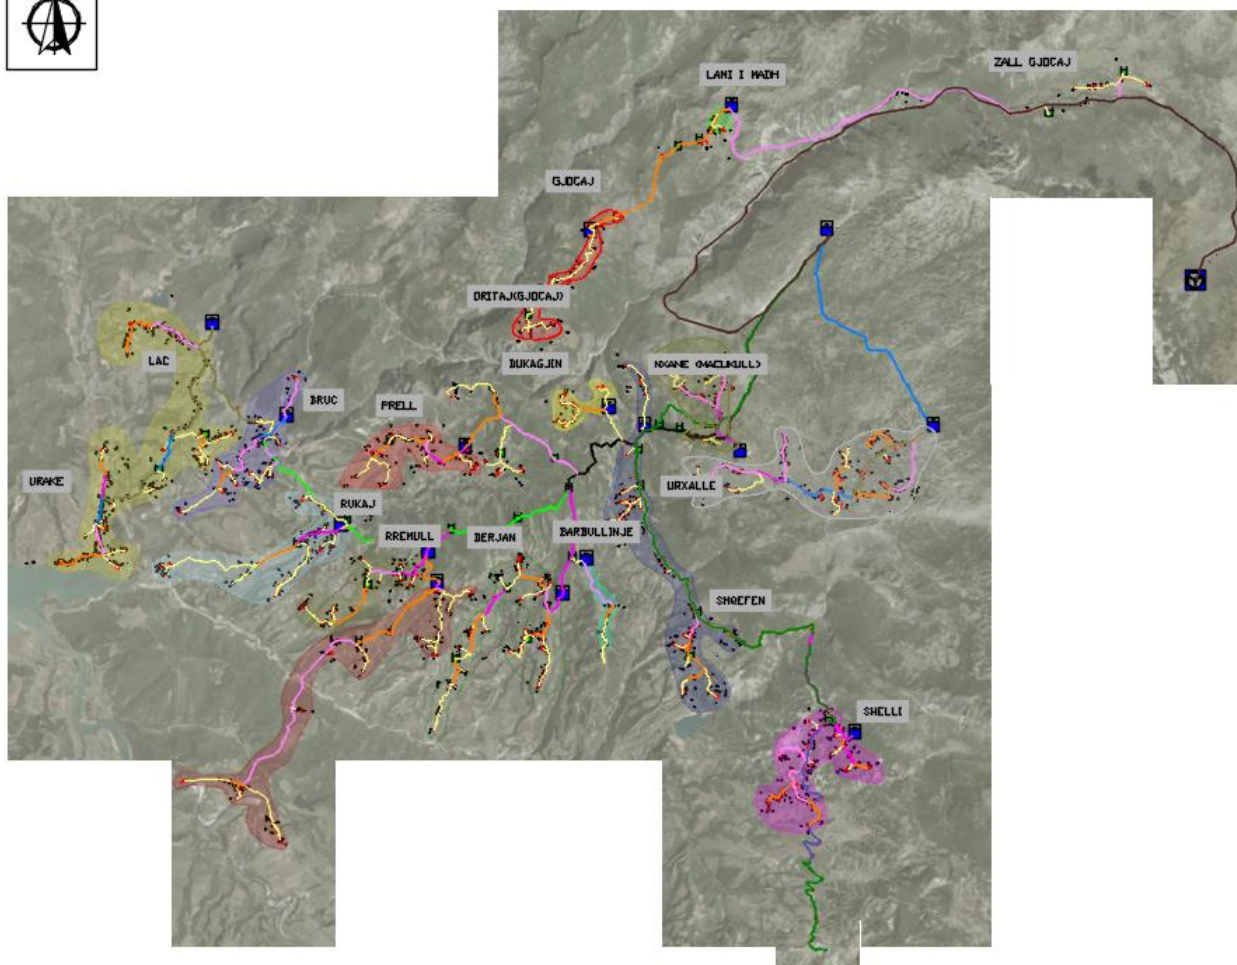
Pozicionet ne planimetri te sistemit te depove ne Derjan dhe Rukaj
